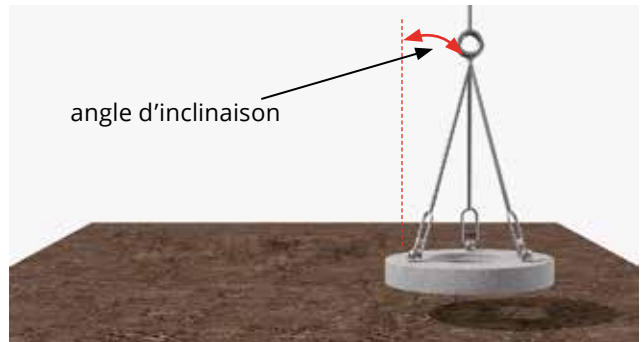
| Soulèvement de la plaque de recouvrement en béton armé
